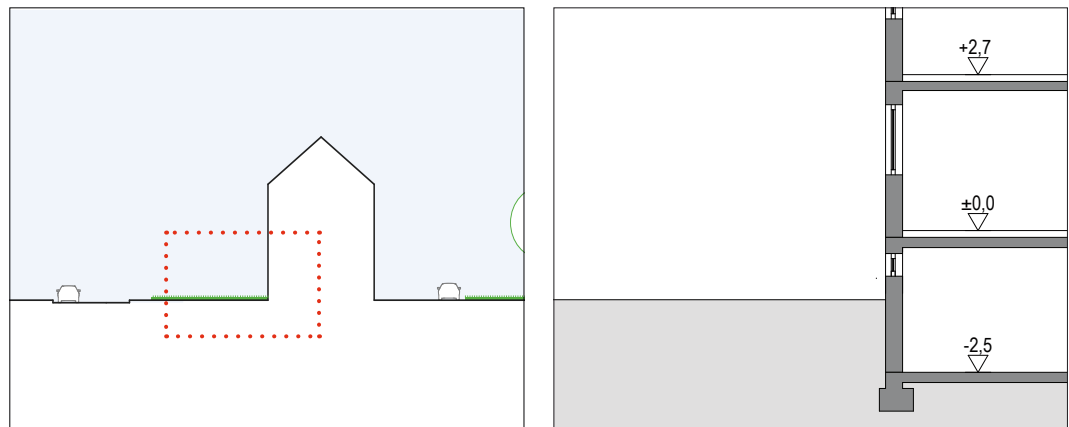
Erdgeschoss- zone ohne Bezug zum Außenraum, Zugangstrep- pe zum Keller, Altbestand (Weiden)
